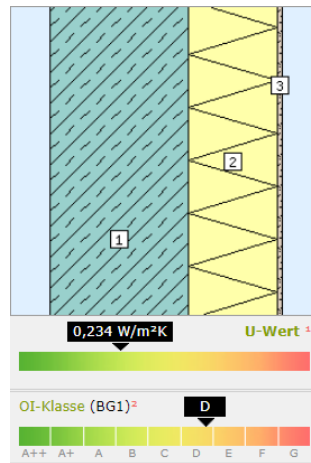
Konventioneller Bauteilaufbau, Stahlbeton Wand
